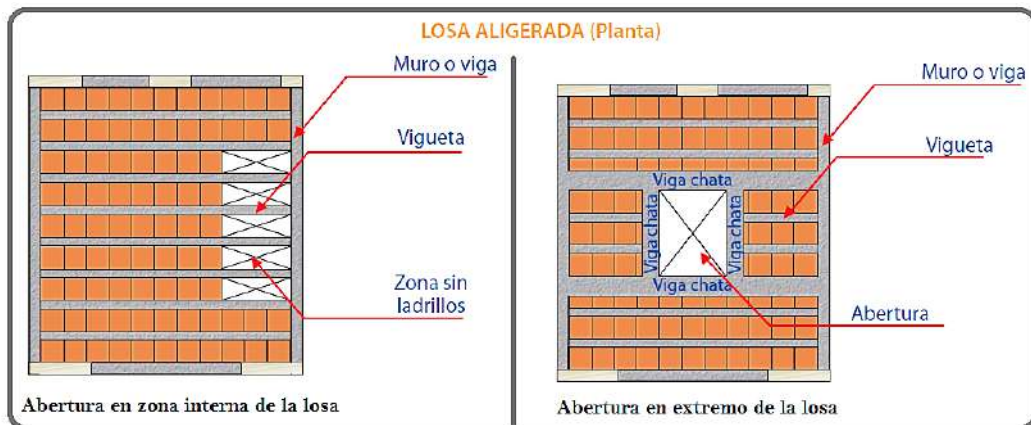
Adecuado arriostramiento en aberturas de una losa aligerada.
